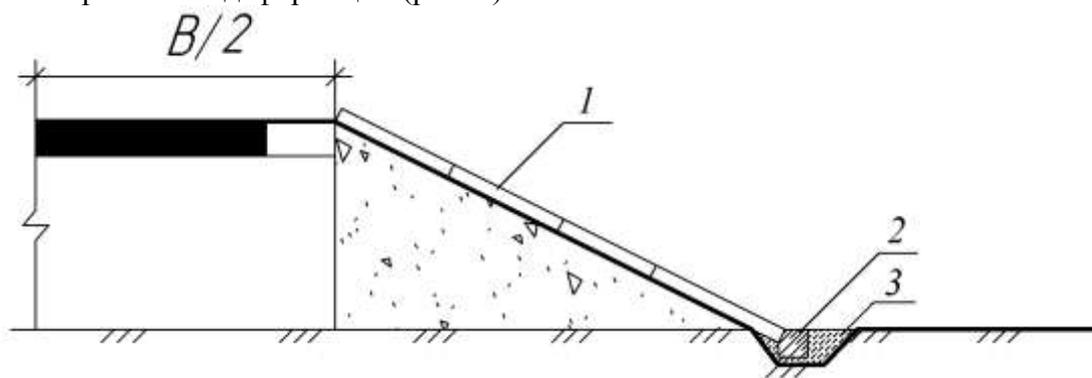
Поперечный профиль укрепления насыпи решетчатой конструкции: 1 – решетка; 2 – бетонный упор; 3 – каменная наброска
